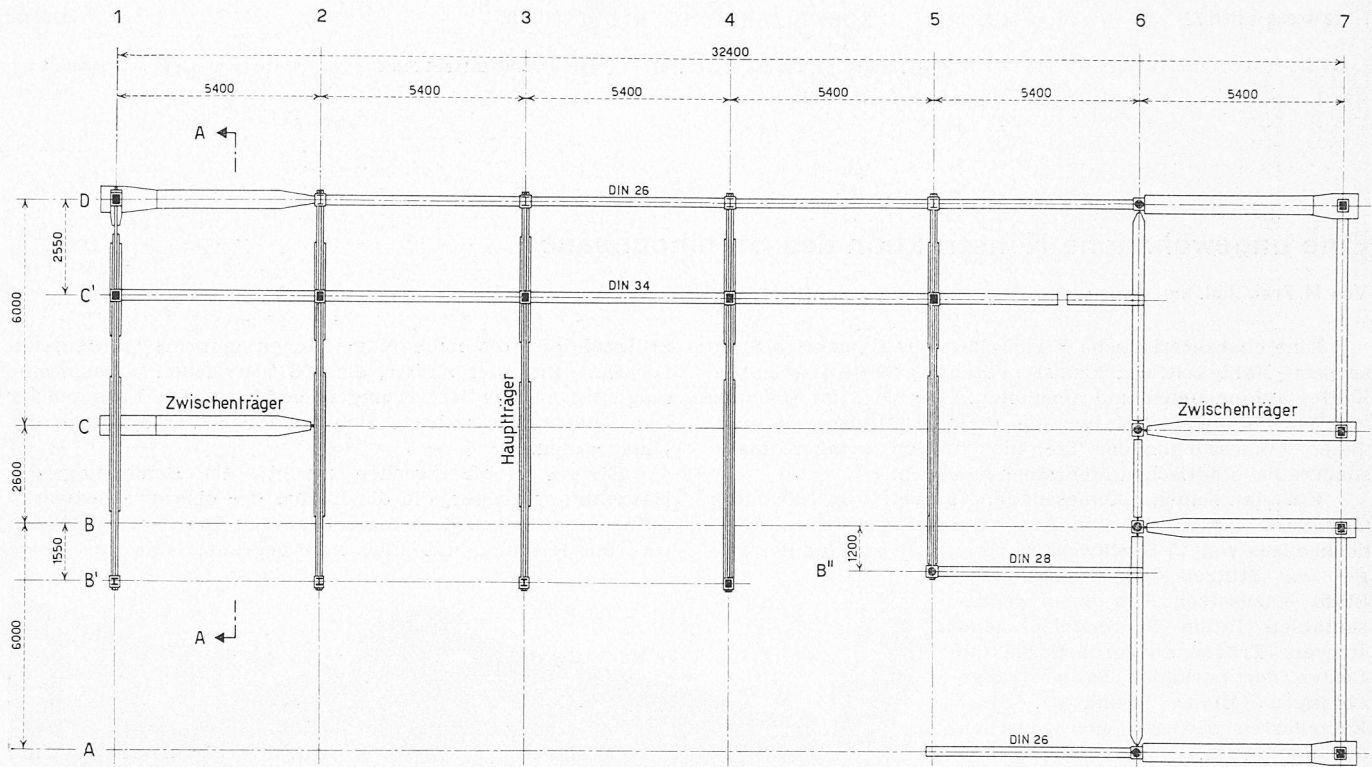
Übersicht der Stahlkonstruktion, Grundriss 1:200
